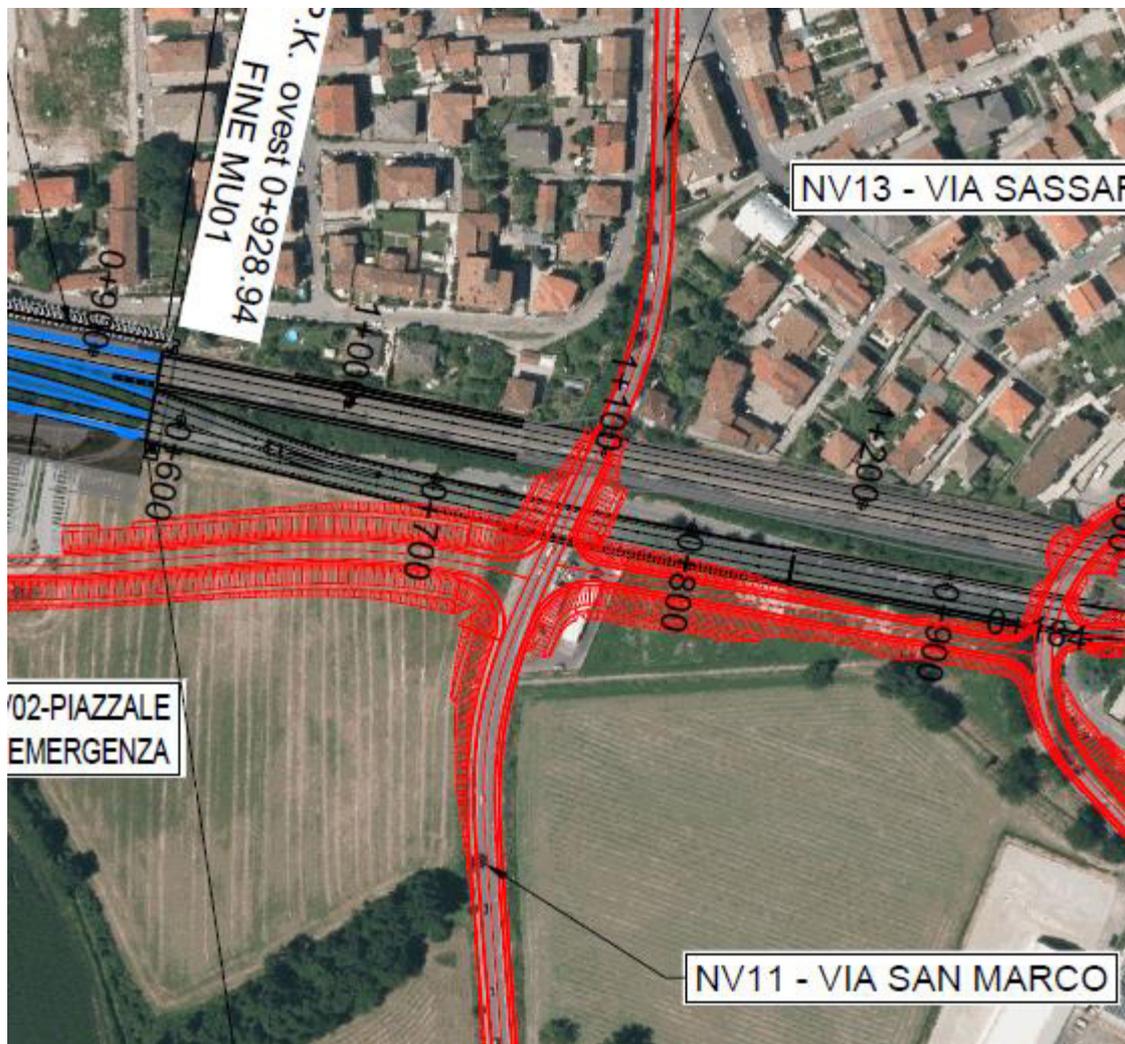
NV11 – Stralcio planimetrico su ortofoto Via San Marco.
